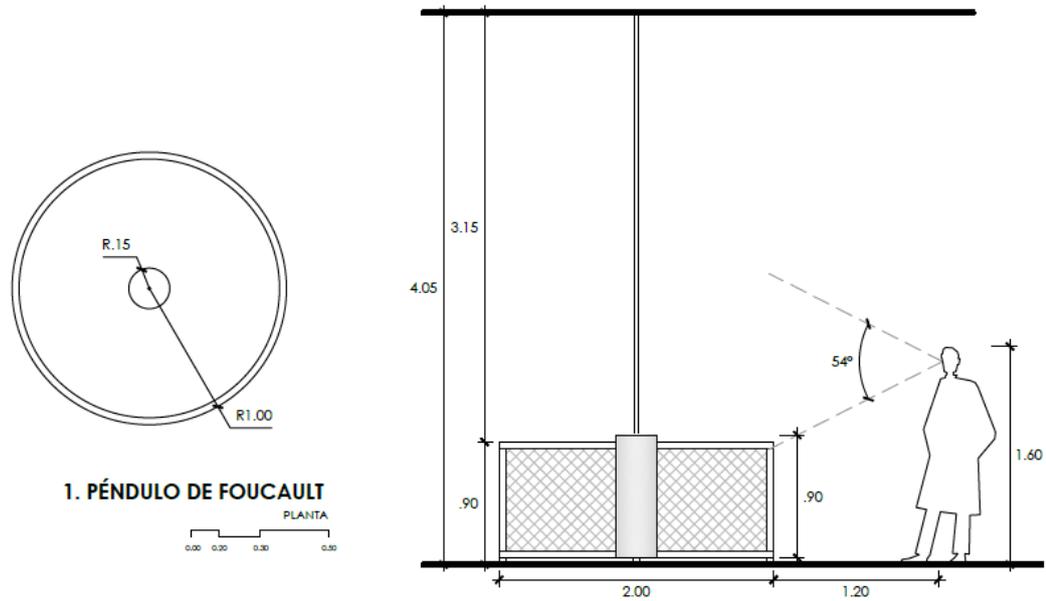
Detalle en corte y planta del Mobiliario tipo I
